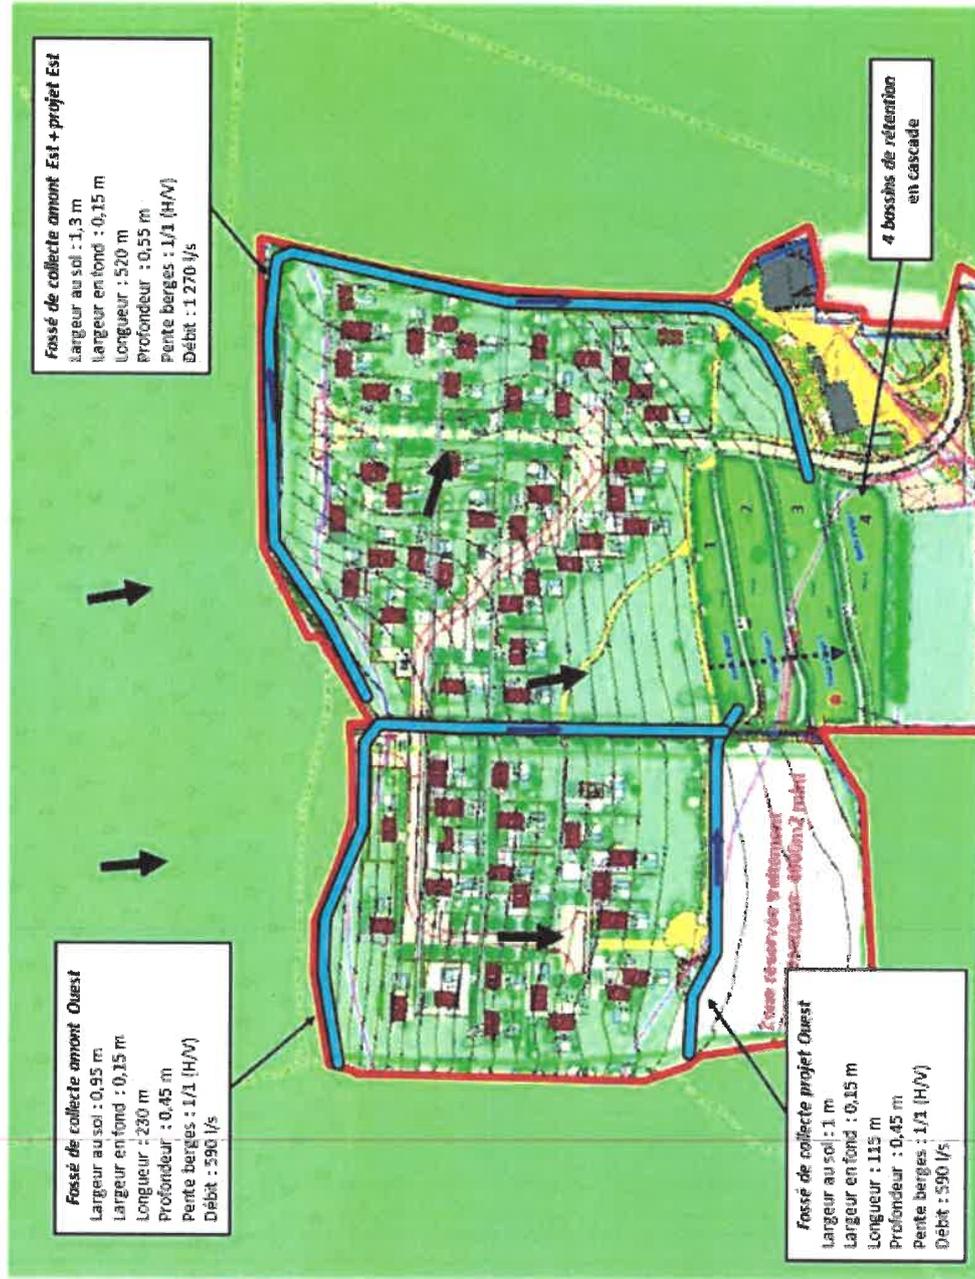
Plan de principe du système de gestion des eaux pluviales
